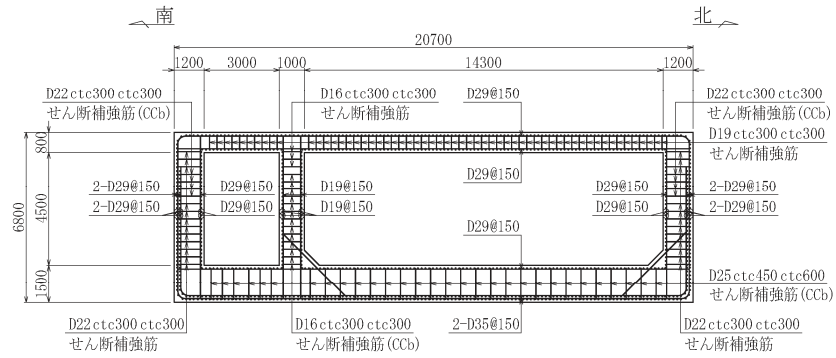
軽油タンク室概略配筋図 (A-A 断面, 南北)
